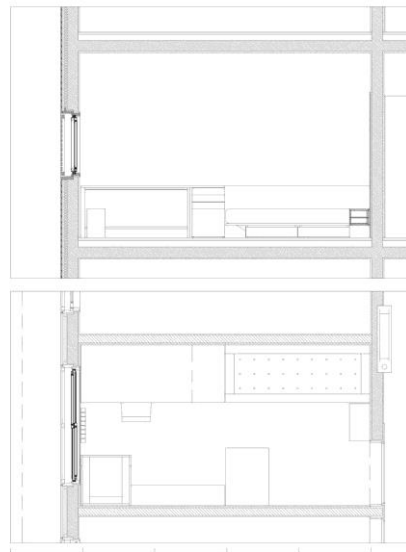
Planta tipo, FUENTE: Arch Daily
